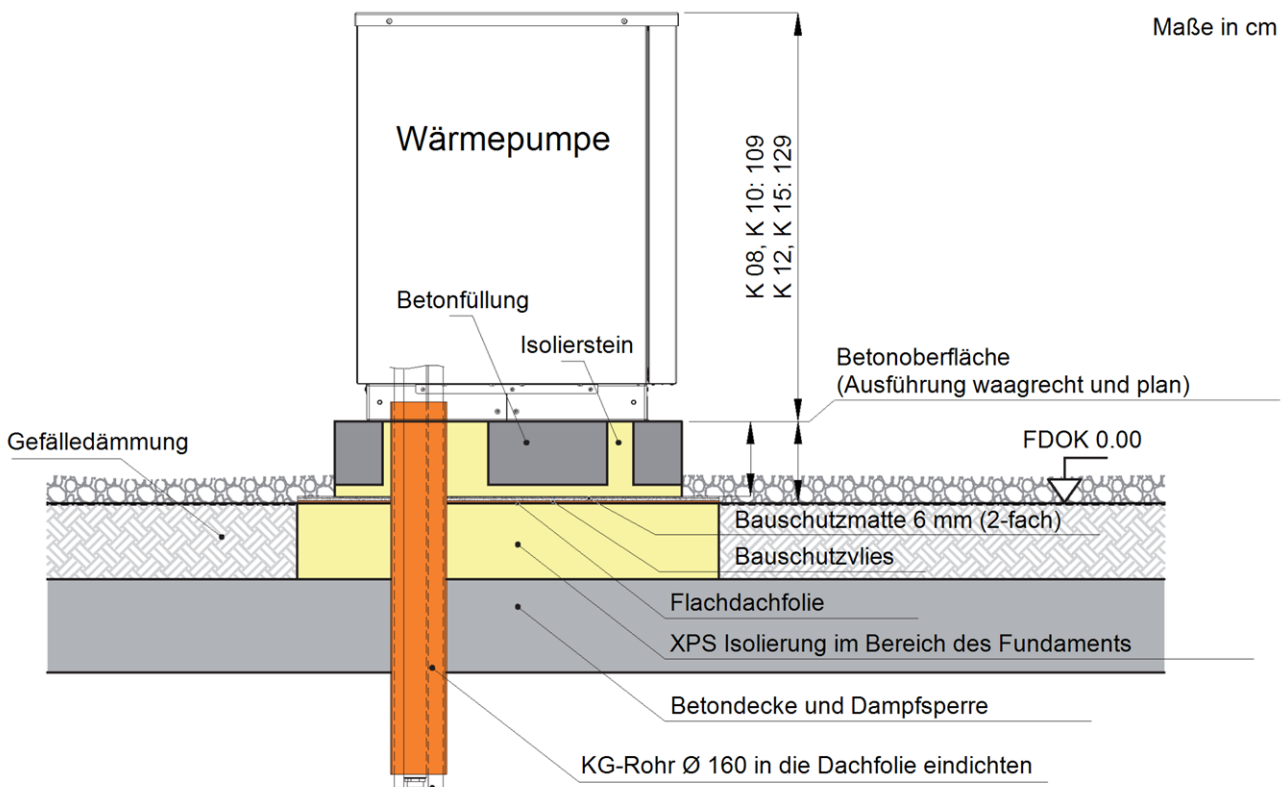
Detail A (Abbildung zeigt das Wärmepumpenrohr DA 40)
